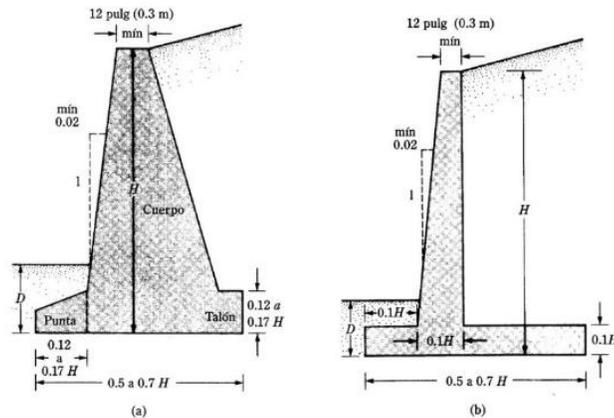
a) Muro de gravedad; b) Muro en voladizo.
